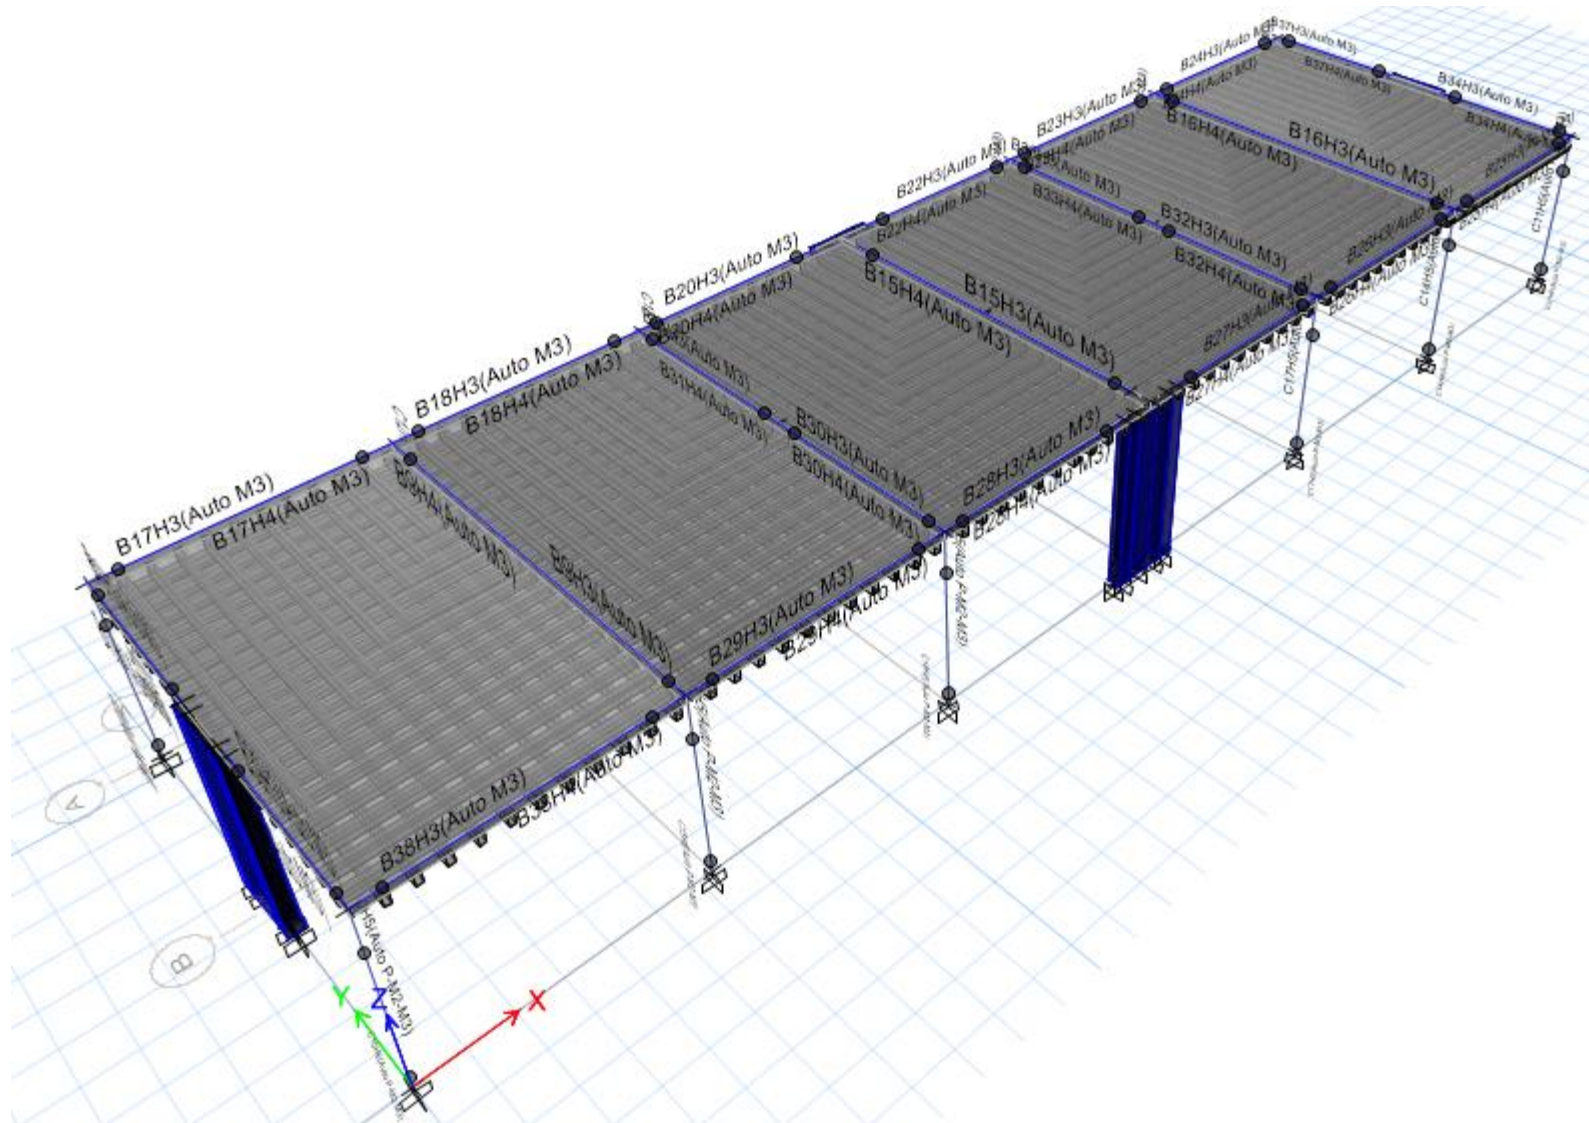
Rotulas Plásticas Vista en 3D en el Software Etabs V.16.2.1
